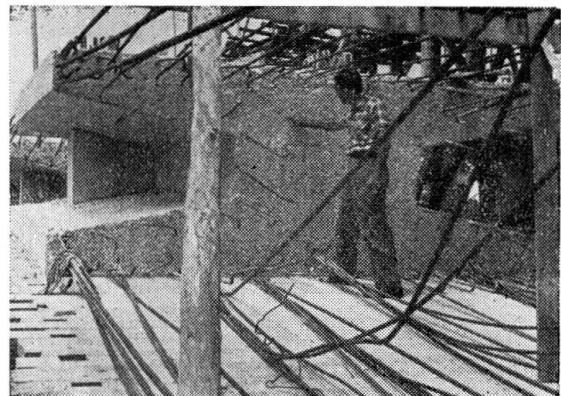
Pormenor da secção duma aduela do arco da ponte da Foz do Sousa
